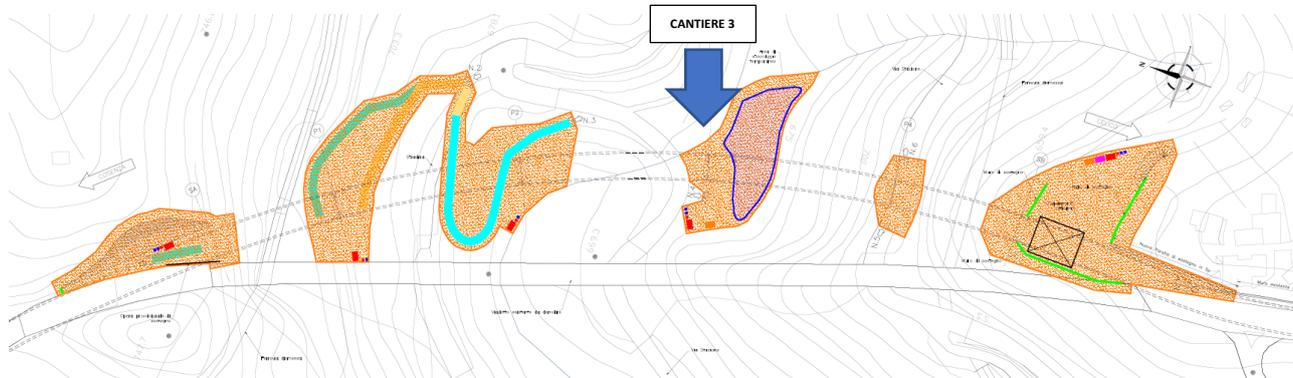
Estratto elaborato V382021000APA "Planimetria aree di cantiere e viabilità di servizio"
